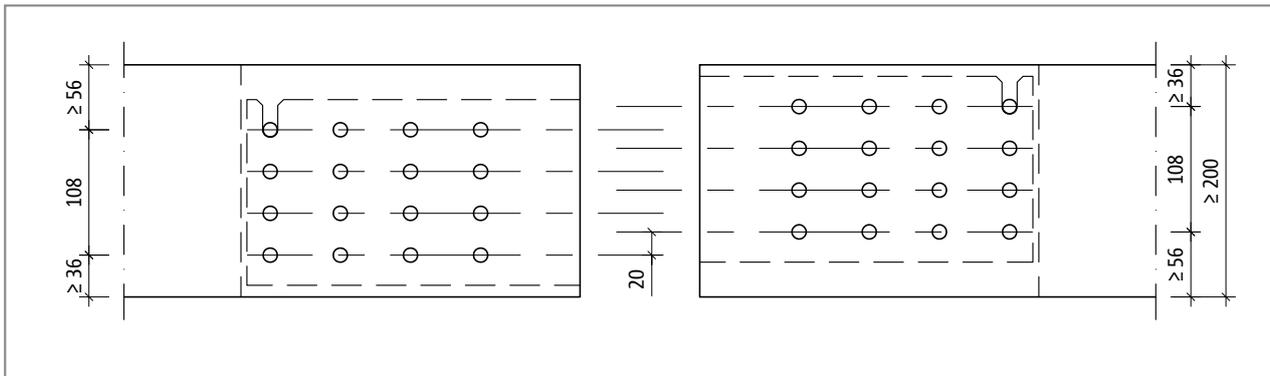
Schöck Isokorb® T Typ SK mit Stahlschwert: Abbund der Holzbalken für den Anschluss an der Außenecke
